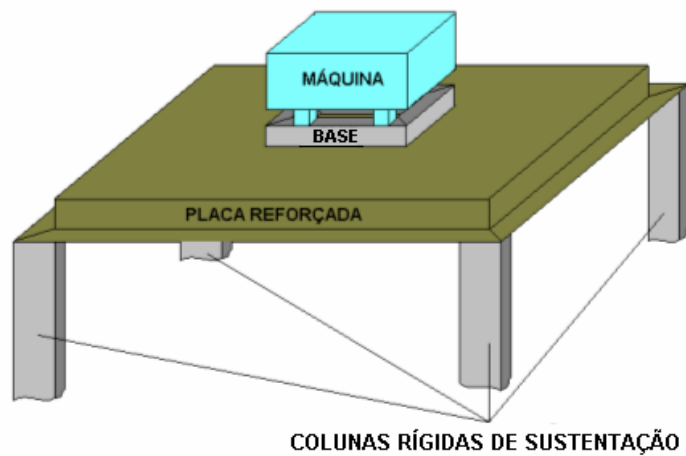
Condição de contorno da placa reforçada por vigas.
